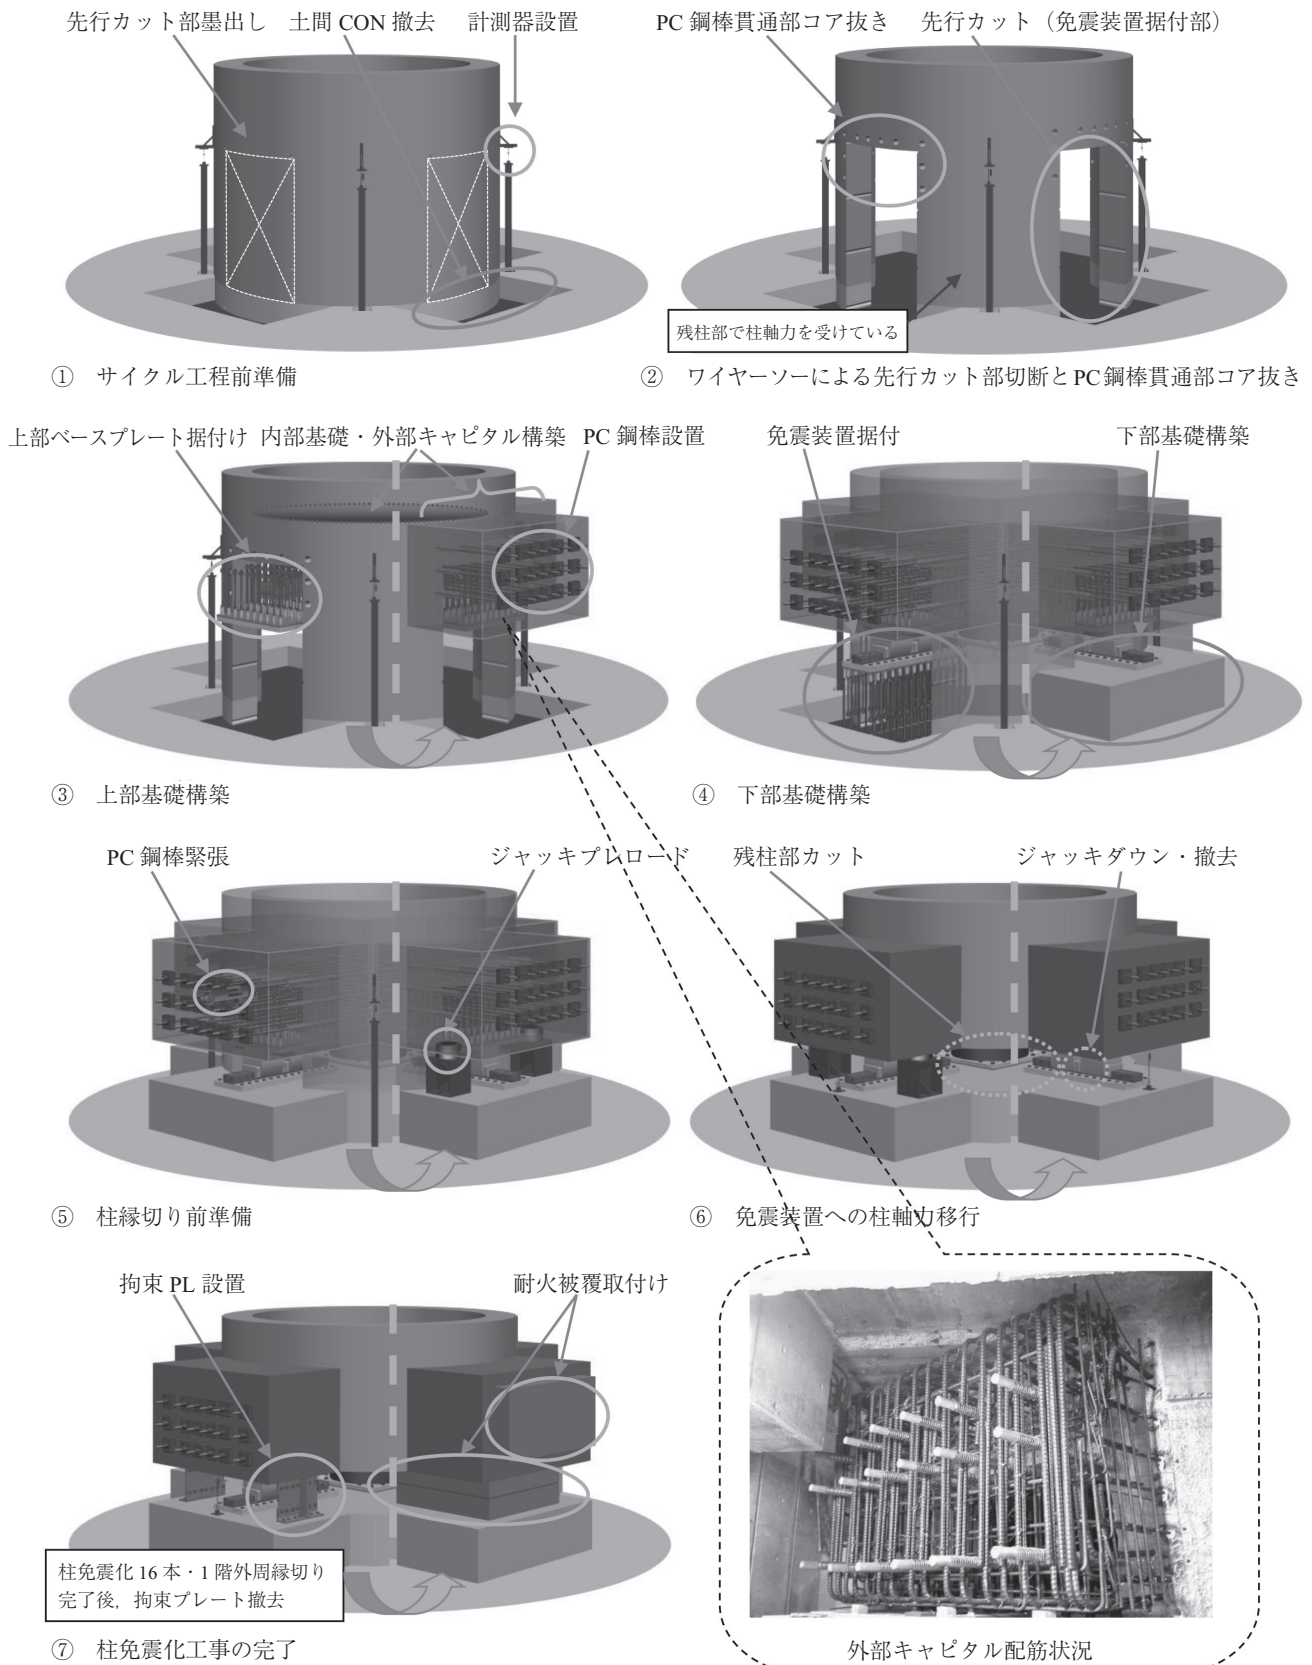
X 型基礎の施工フローと外部キャピタル配筋状況
